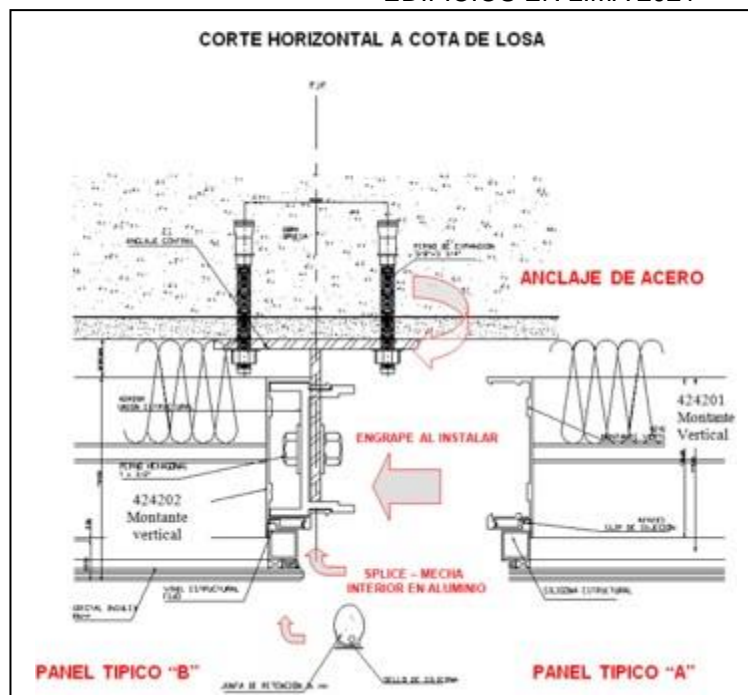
Detalle de fachada tipo Frame y el despiece en un corte horizontal para indicar las ubicaciones.
